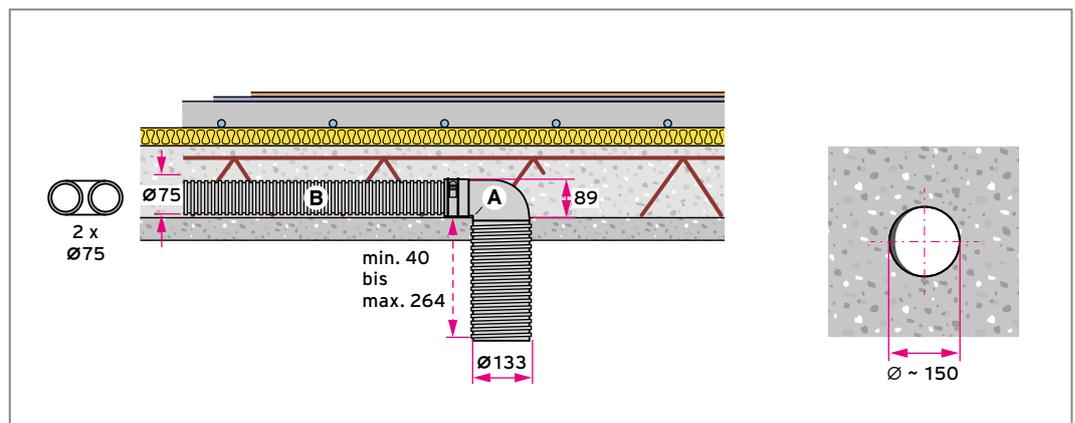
Luftein-/auslassverlegung in der Rohbetondecke
